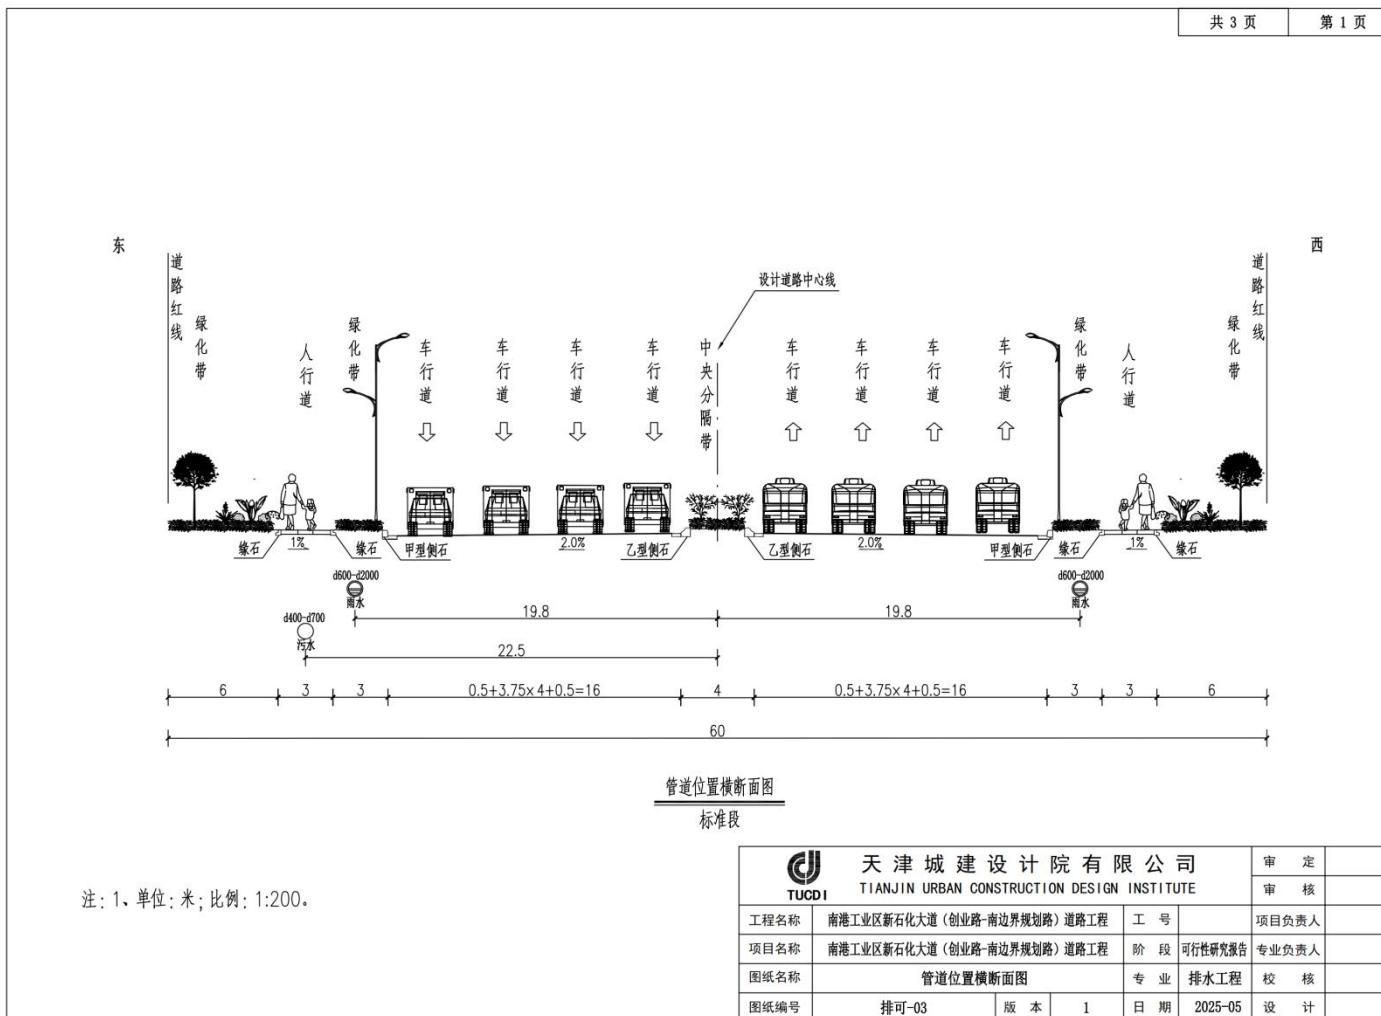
南堤路以北标准段雨水、污水排放管道工程断面图
